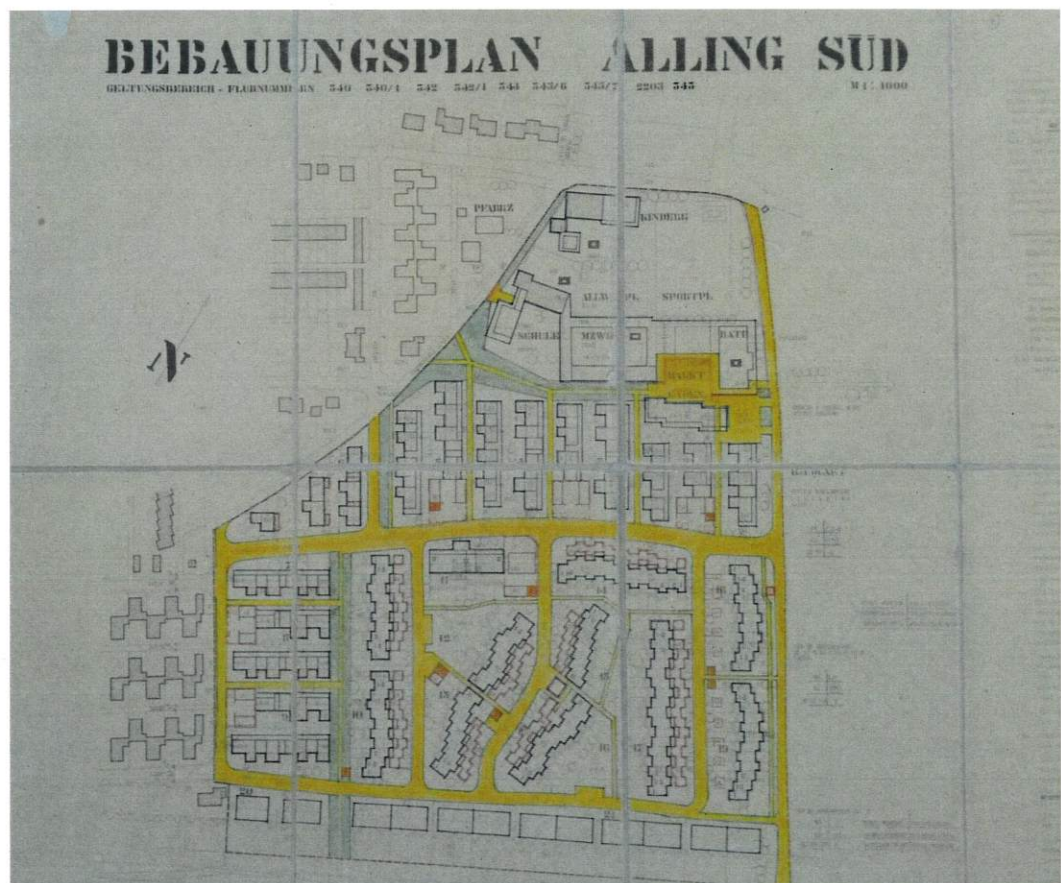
Bebauungsplan „Alling Süd“, i.d.F. 16.07.1974
